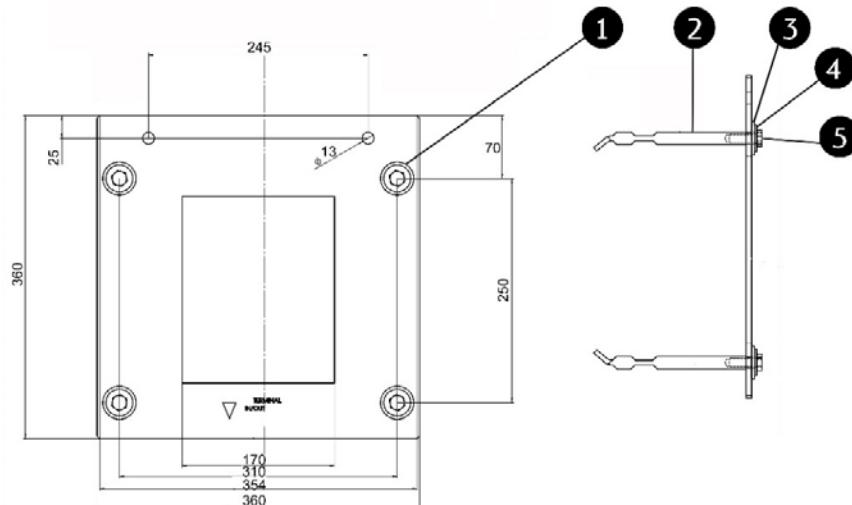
Platine de scellement DESIGNA (dimensions en mm)
